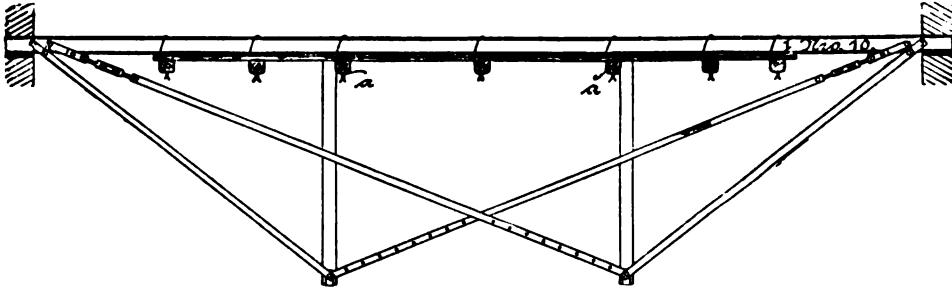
Einrüstung nach Bauweise Leschinsky.
